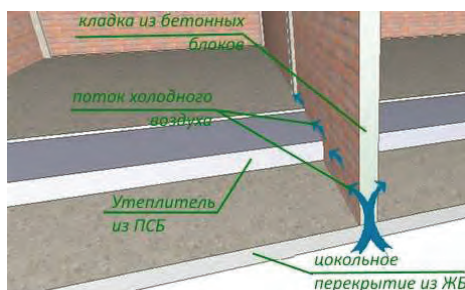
схема потока холодного воздуха в стыке цокольного перекрытия с внутренней стеной.
